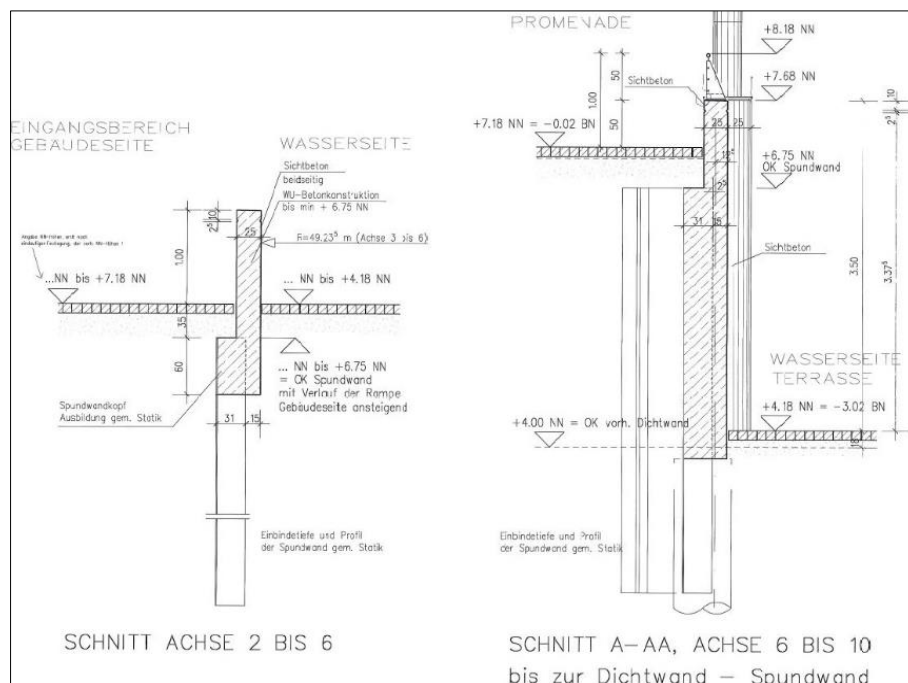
Teilabschnitt I: Schnitte der öffentlichen HWS-Wand (Ausschnitt aus dem Plan 1030, Stand: 04.09.2001)
